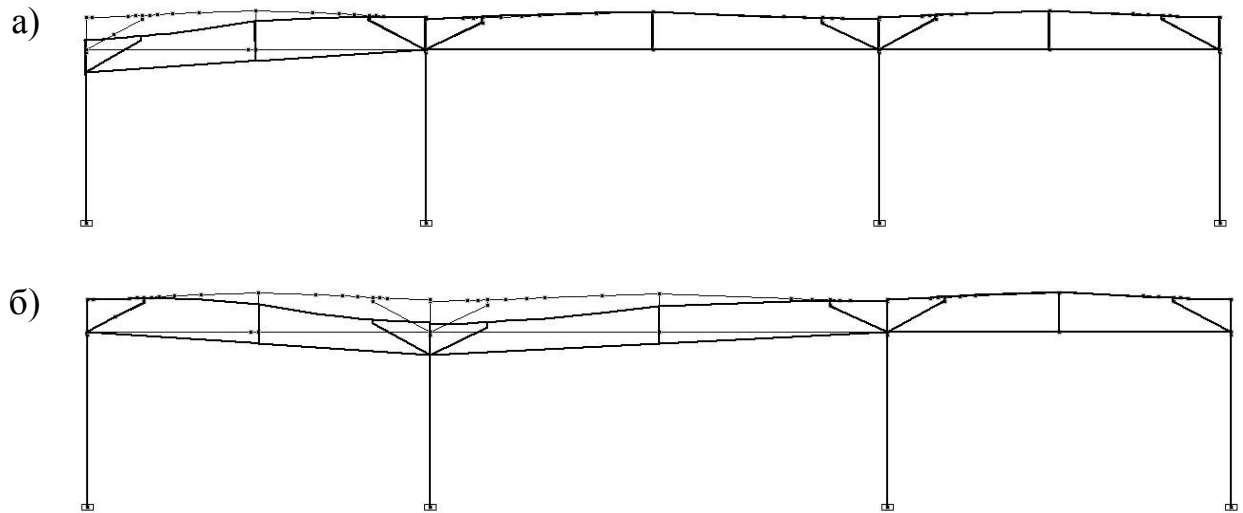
Моделирование неравномерной осадки фундаментов: а) под крайней колонной; б) под средней колонной
